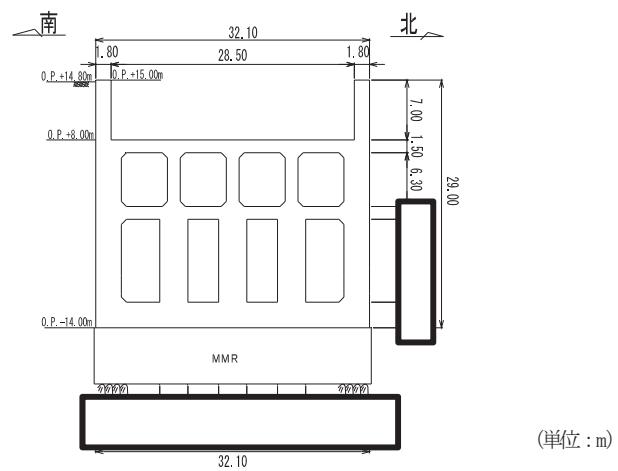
第3号機海水ポンプ室断面図 (A-A)
